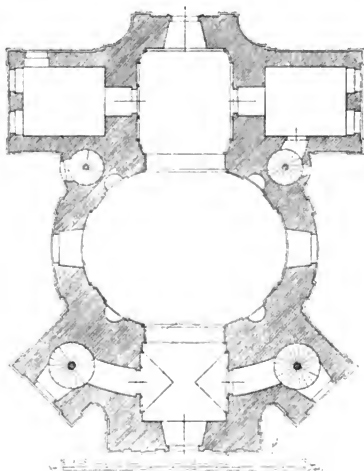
Makowa. Grundriss der Kirche.
